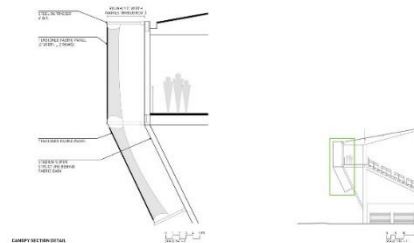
Detalle constructivo del estadio (Rossetti, 2016)
